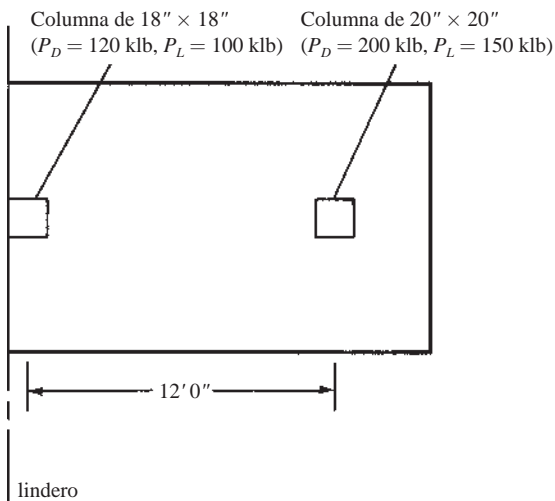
Vista en planta de la zapata combinada del Ejemplo 12.6.
